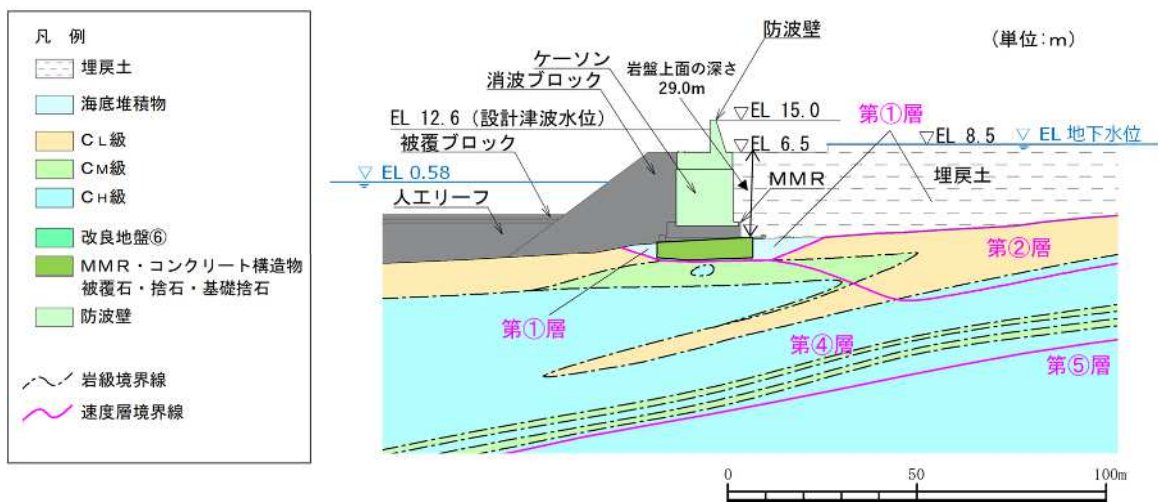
防波壁（波返重力擁壁）の横断面図
